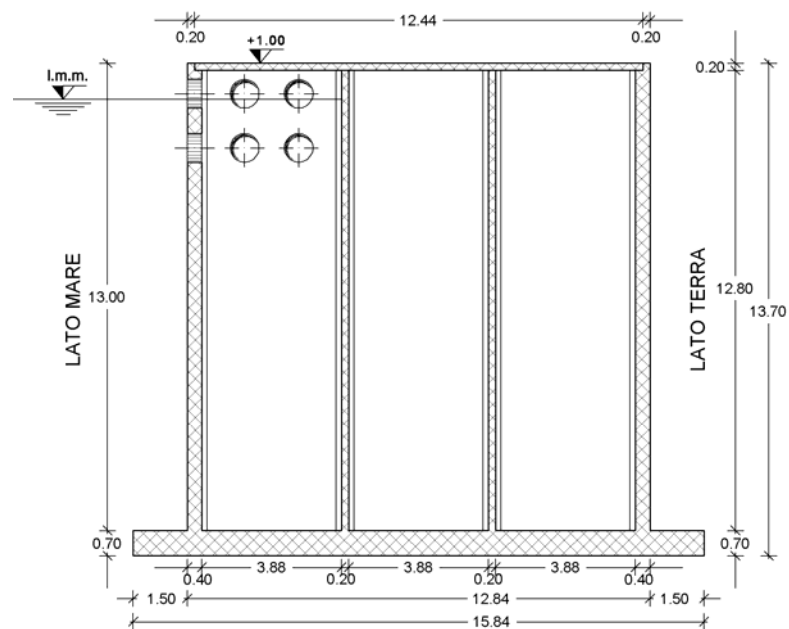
Cassone prefabbricato tipo 3 × 8 celle: sezione verticale trasversale
